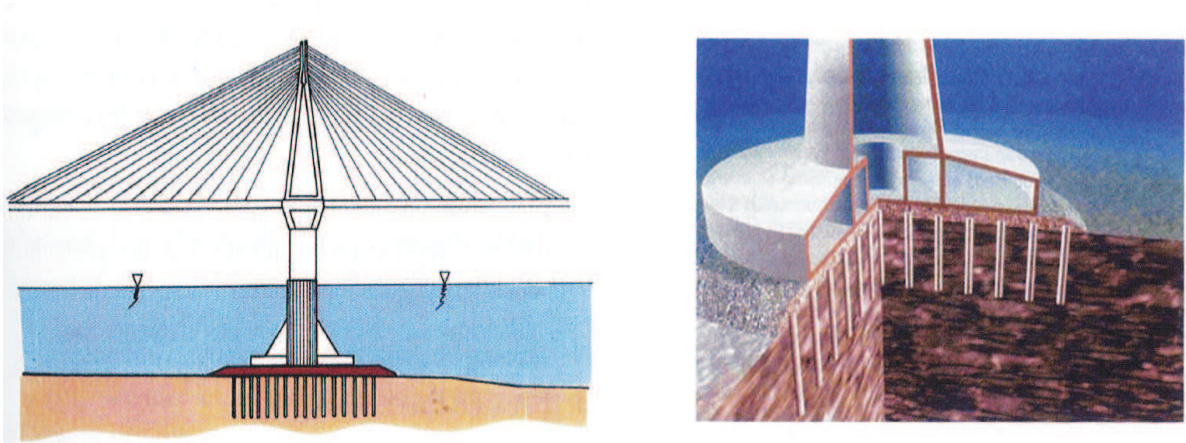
Renforcement des fondations des piles du pont Rion-Antirion
